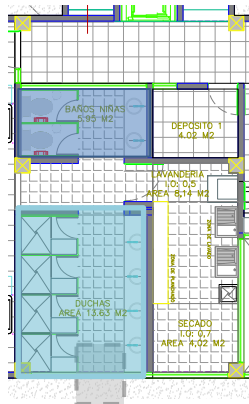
Planta arquitectónica segundo piso I.E Togoima
